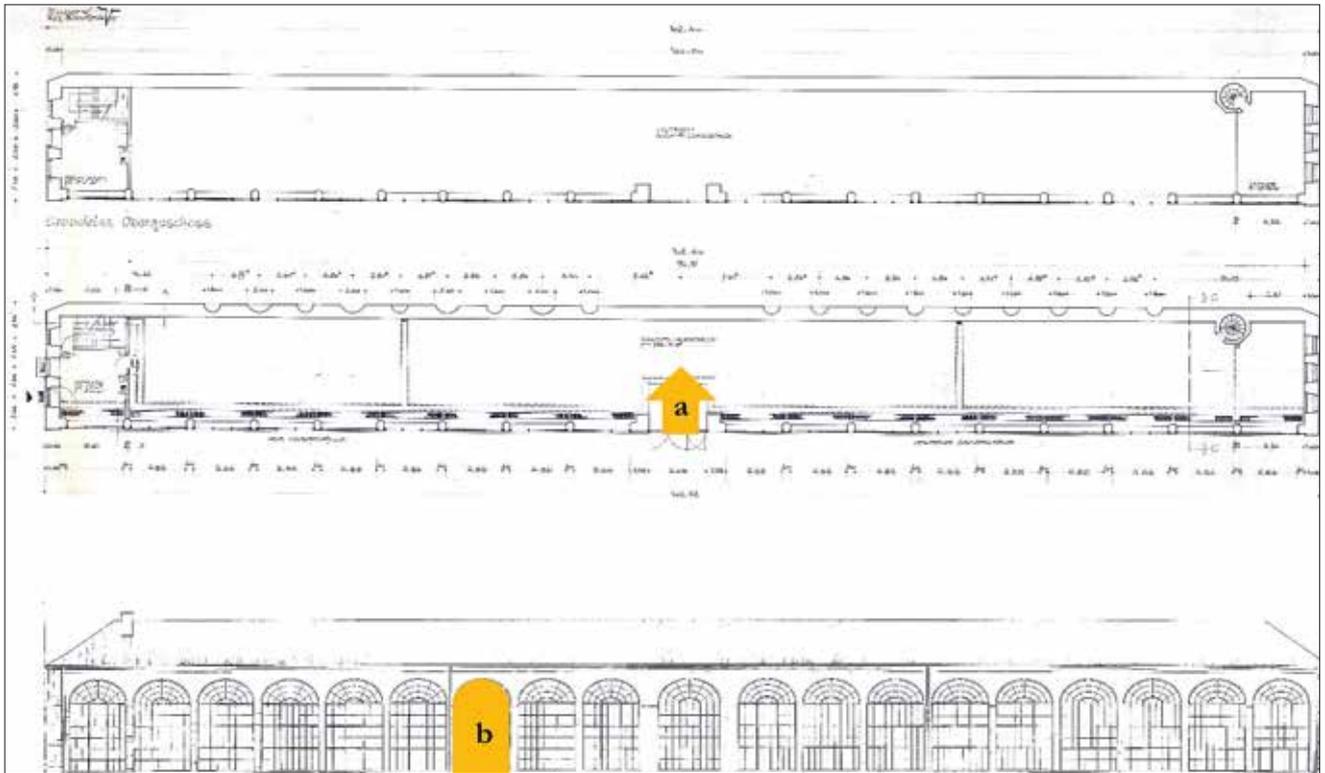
Orangeriegebäude, Planungen zum Wiederaufbau (Planzeichnungen 1966, Mayer Reg. Baudirektor, Landbauamt Würzburg, BSV, Plansammlung Bauabteilung: WÜ-02-04-107 und WÜ-02-04-111)
